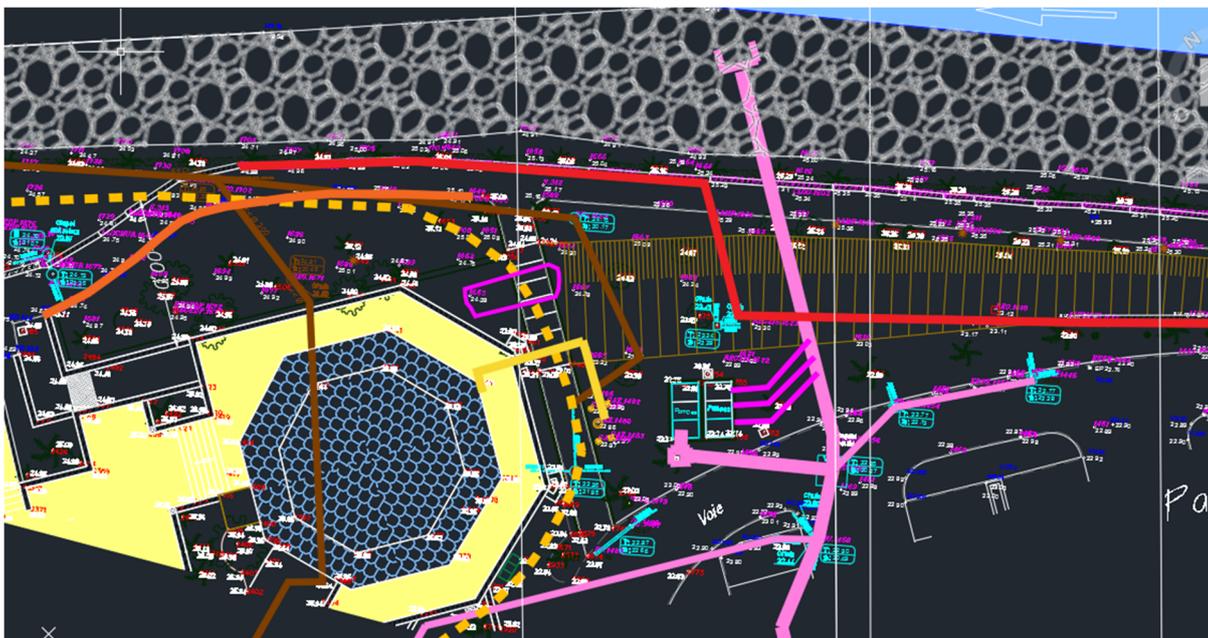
plan de principe d'implantation de l'ouvrage en fonction des réseaux
